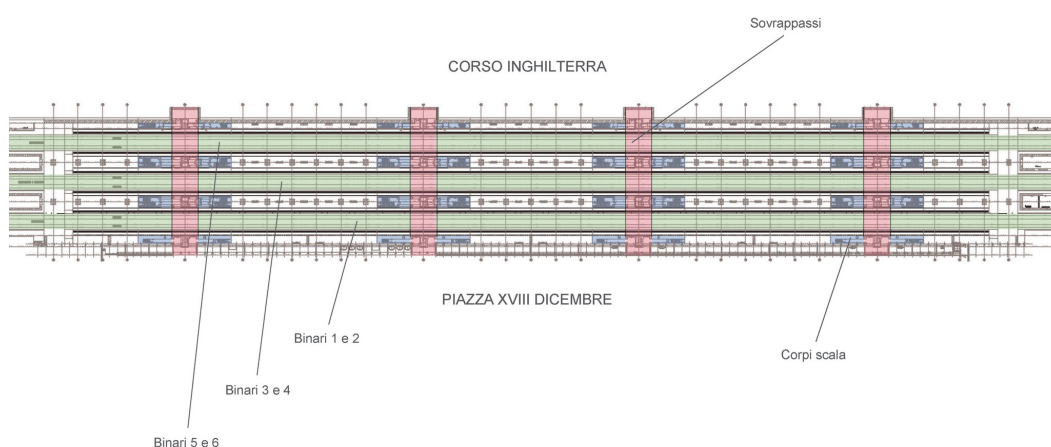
Planimetria della nuova stazione. *Plan of new rail station.
